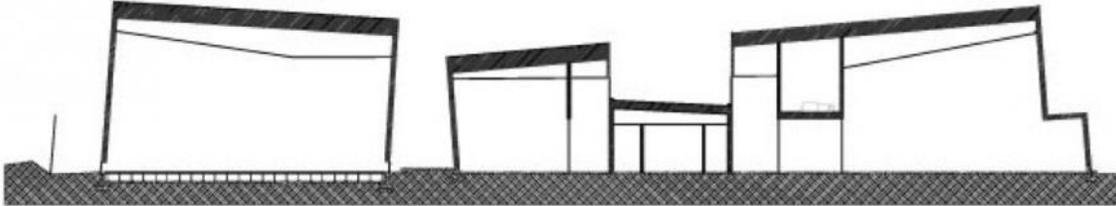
Diagrama de corte, marcando sección de la techumbre utilizada para vegetación. Imagen extraída de Arch Daily
